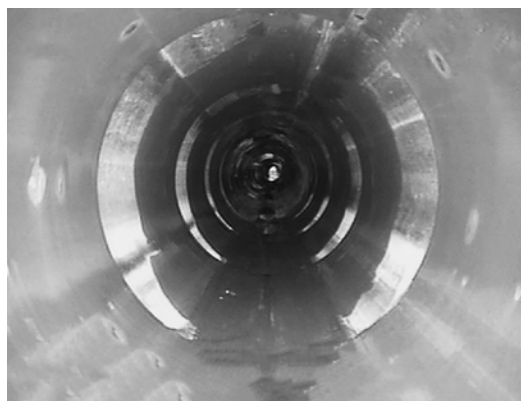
管更生工施工後の管内の状況 (SSL-L工法)
